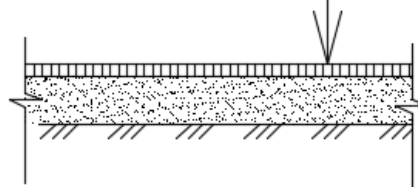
Конструкция восстанавливаемого асфальтобетонного покрытия тротуара
